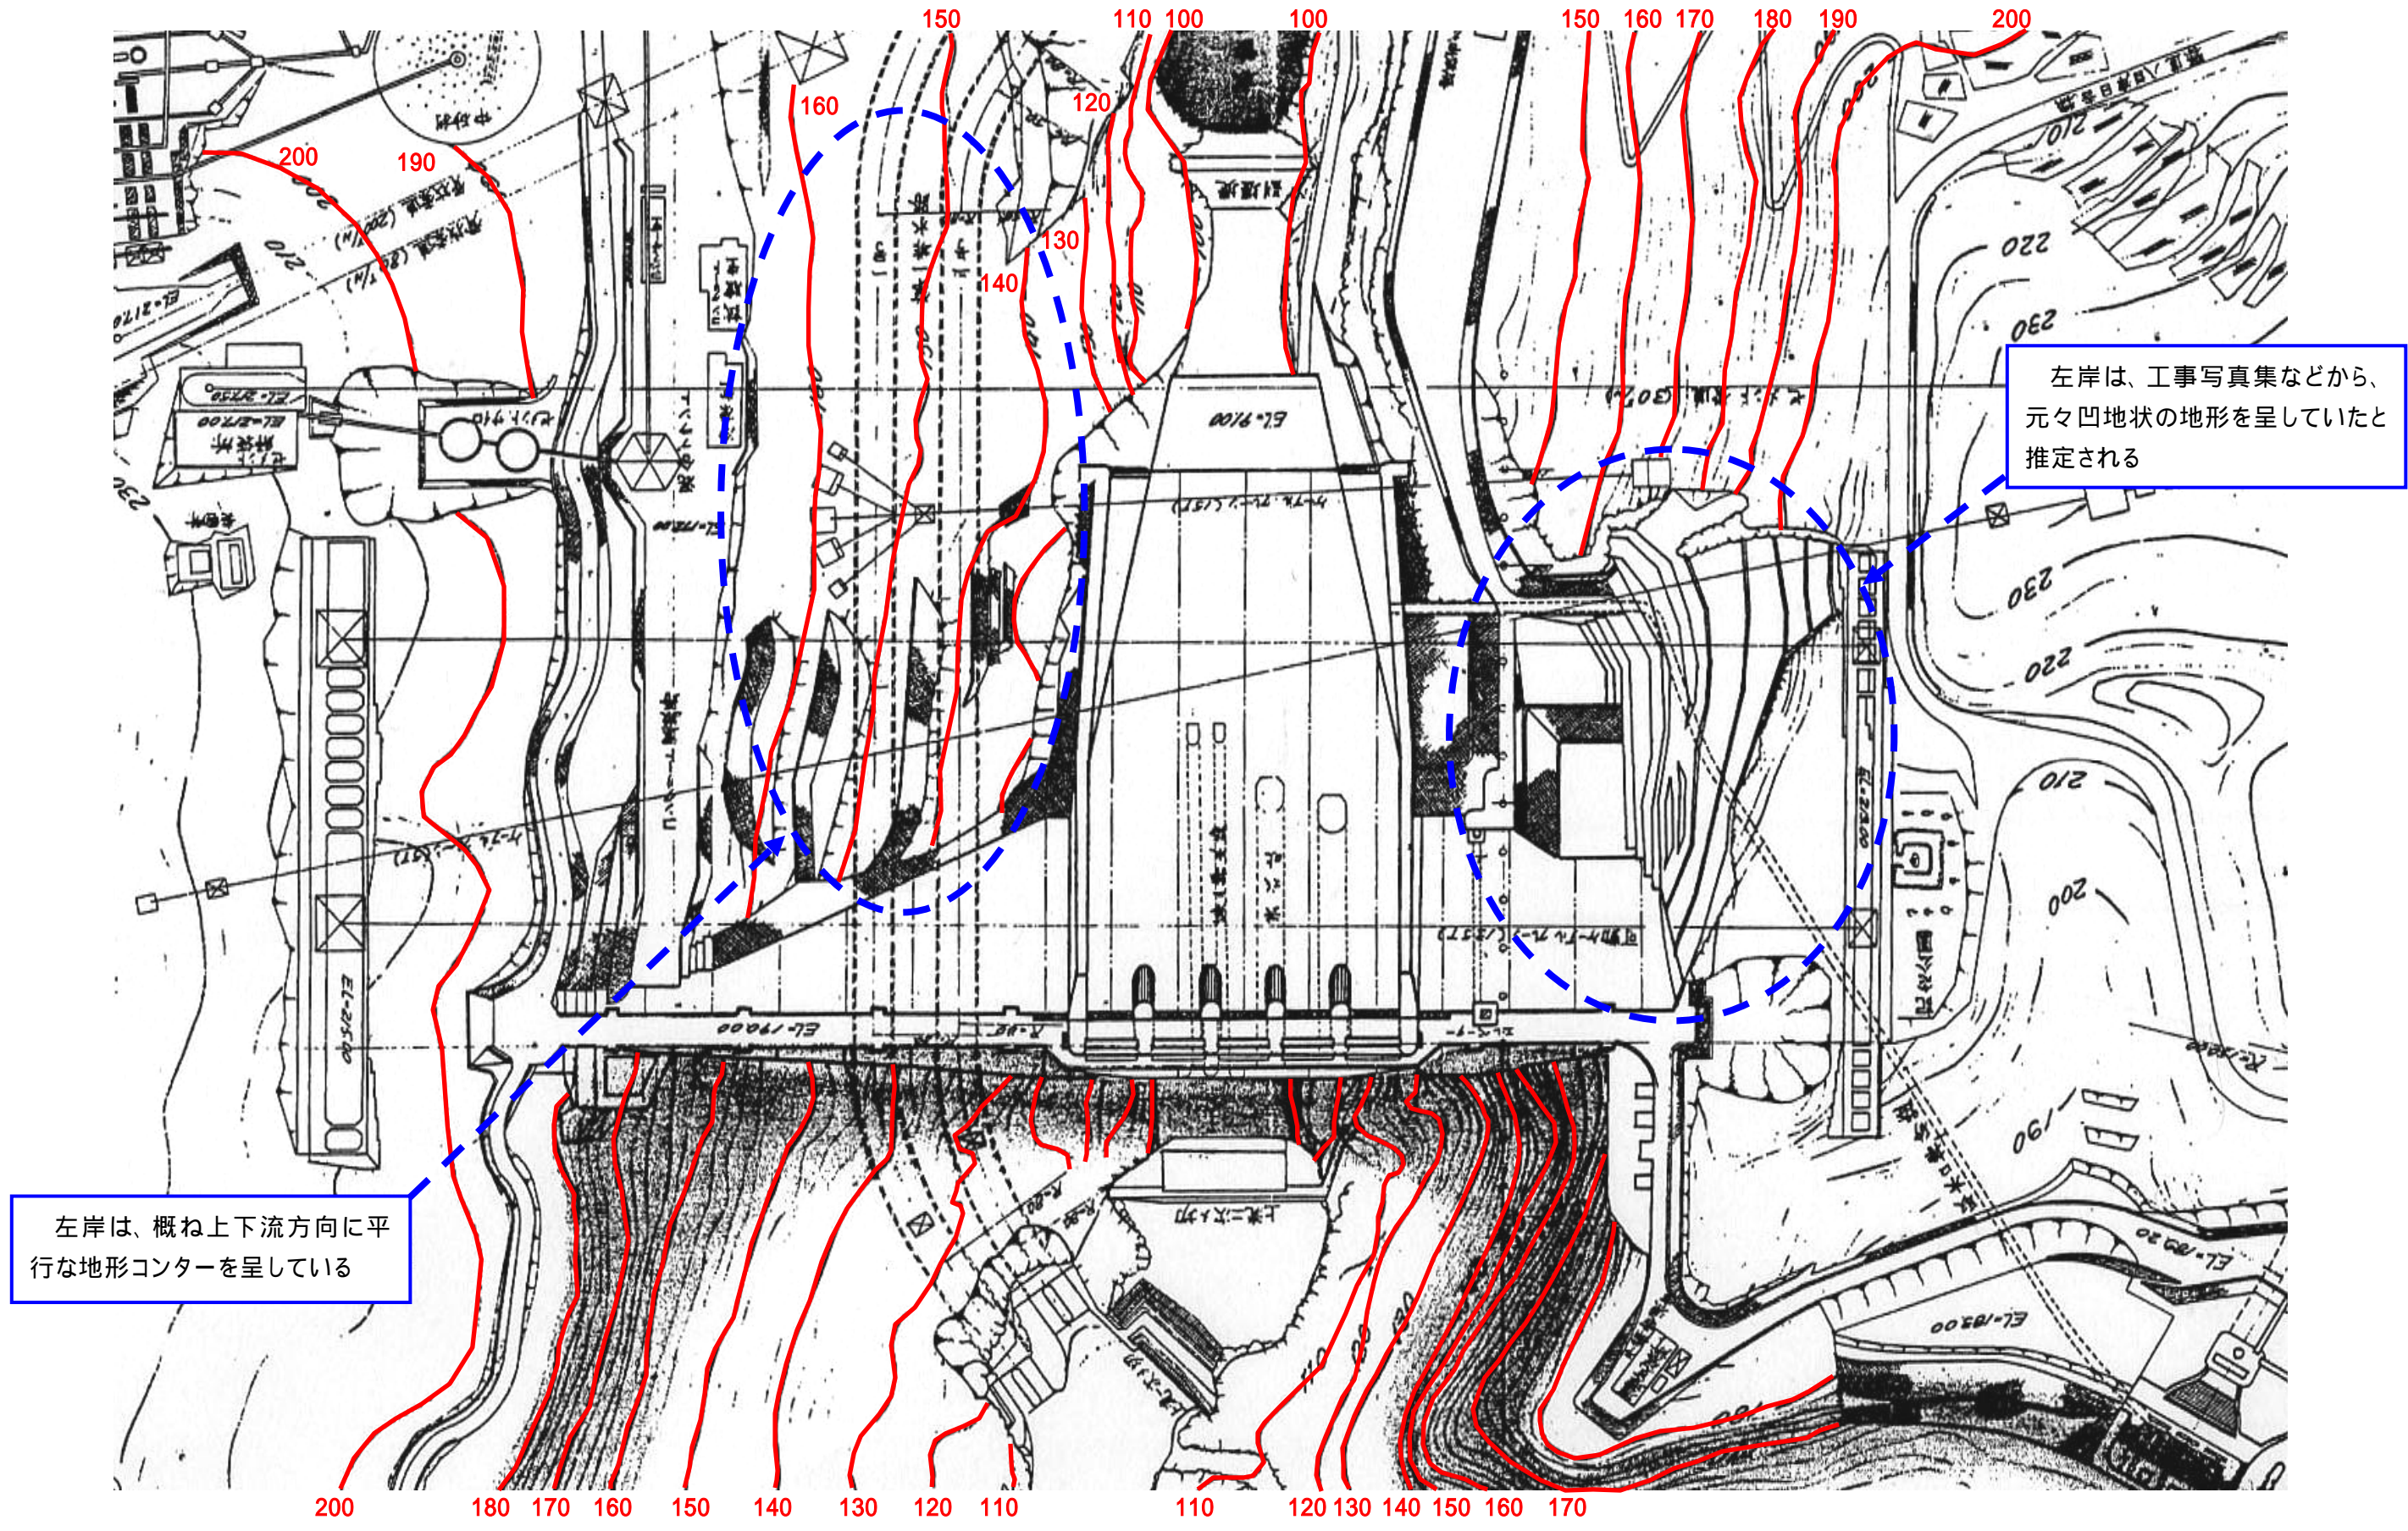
丸山ダム建設時のダム付近平面図
